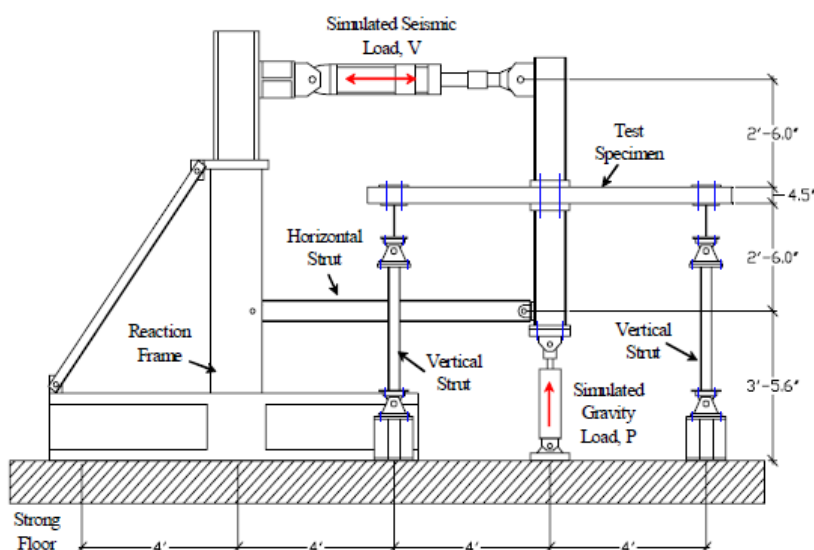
Sistema de ensaio utilizado por Stark et al. [40]
